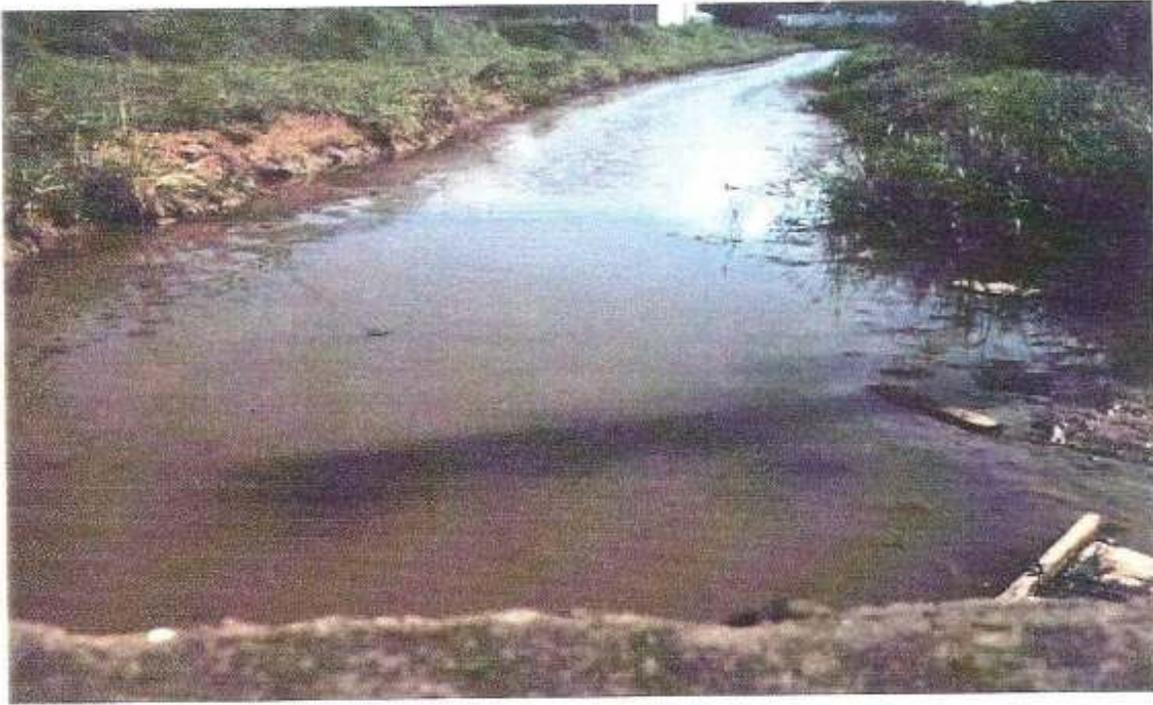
Llegada a alcantarillas de 4.5 pies sobre la carretera PR-64
